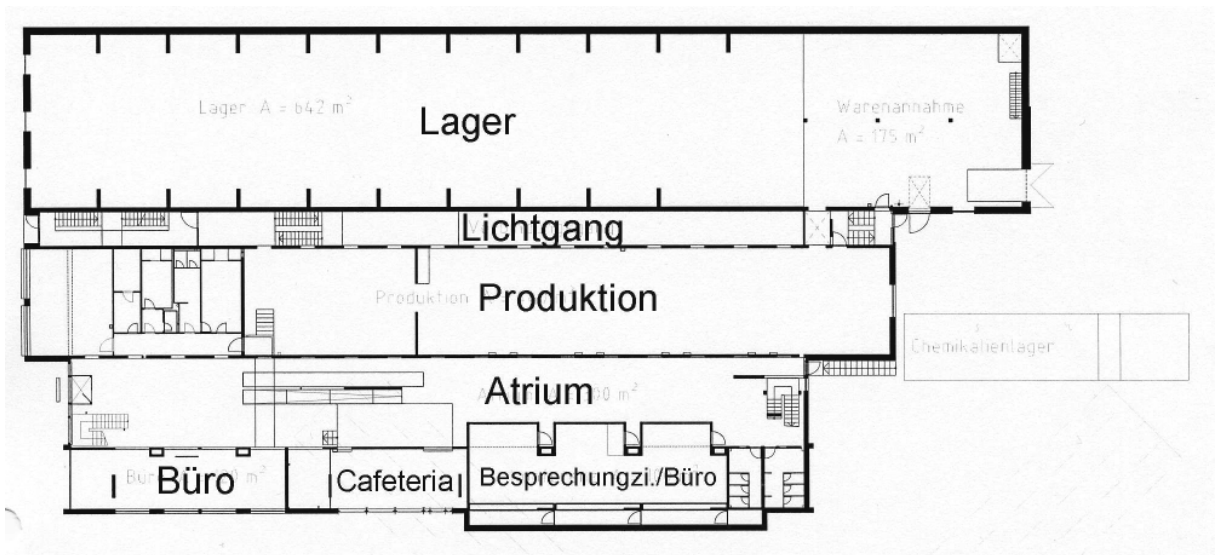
Grundriss EG mit den Bereichen Lager, Lichtgang, Produktion/Labor, Atrium und Büro/Cafeteria/Besprechungszimmer.
